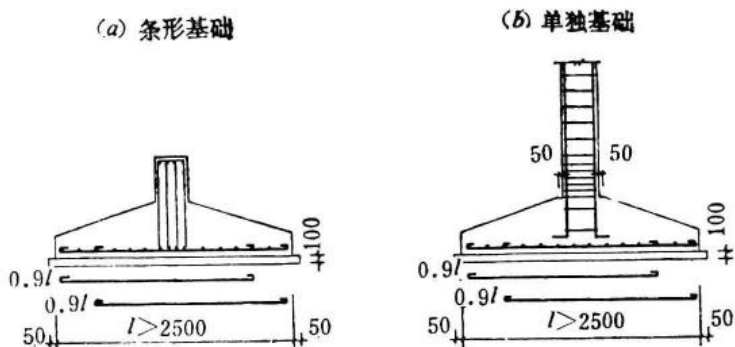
1 钢筋混凝土条基 $l > 2500$ 配筋剖面
